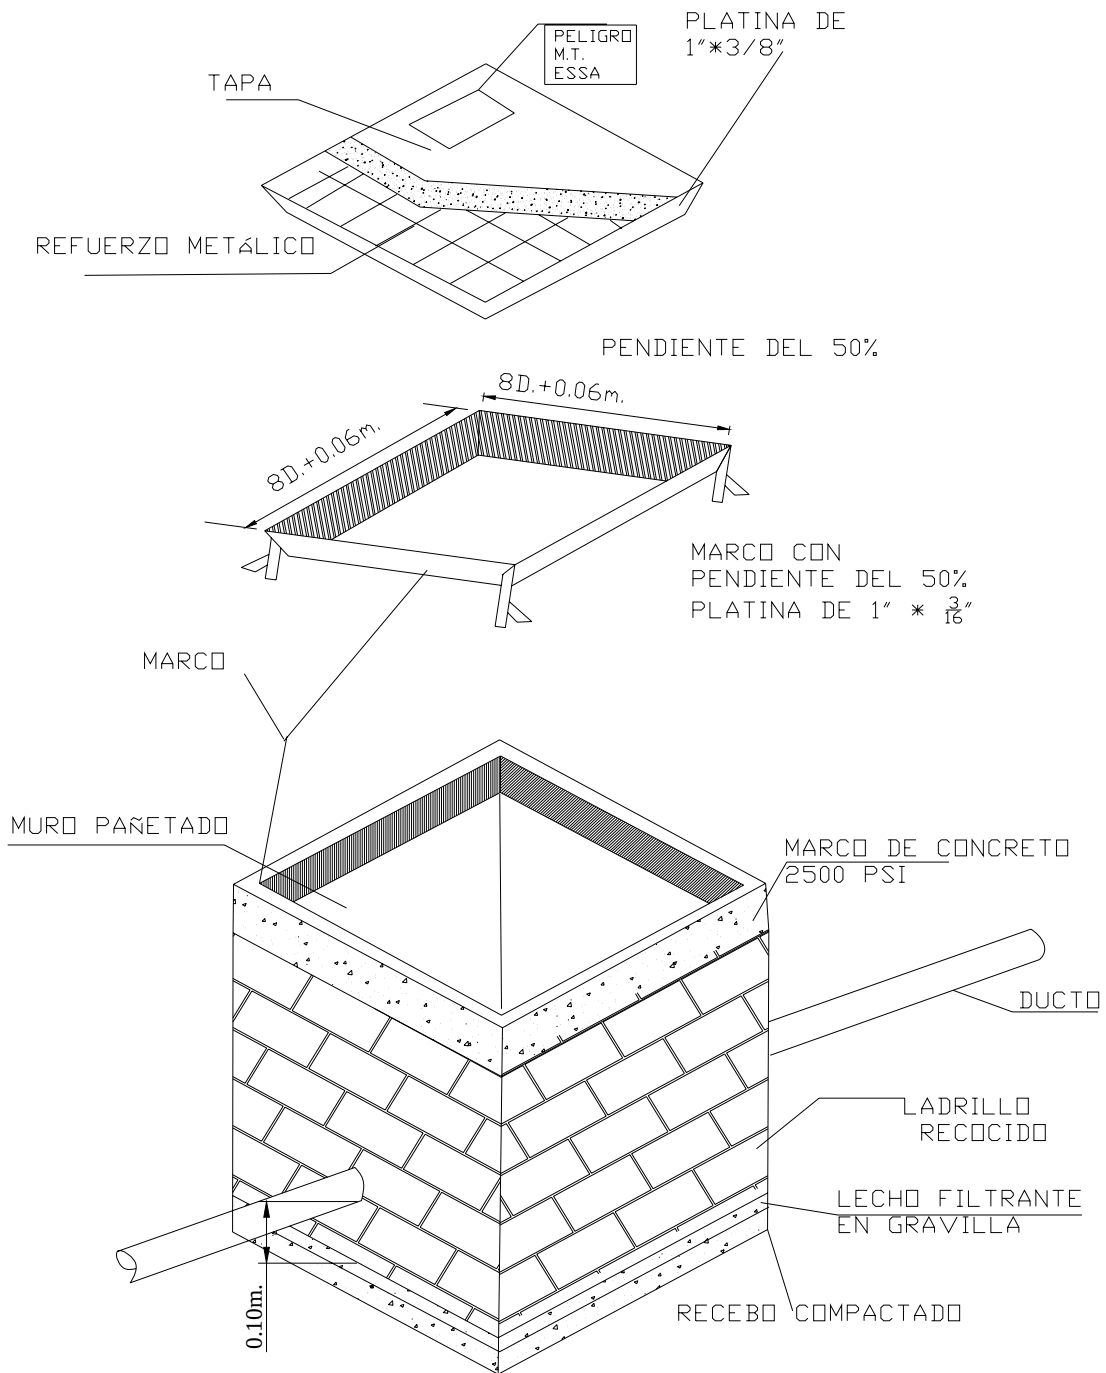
Caja de inspección en MT. Vista isométrica.
